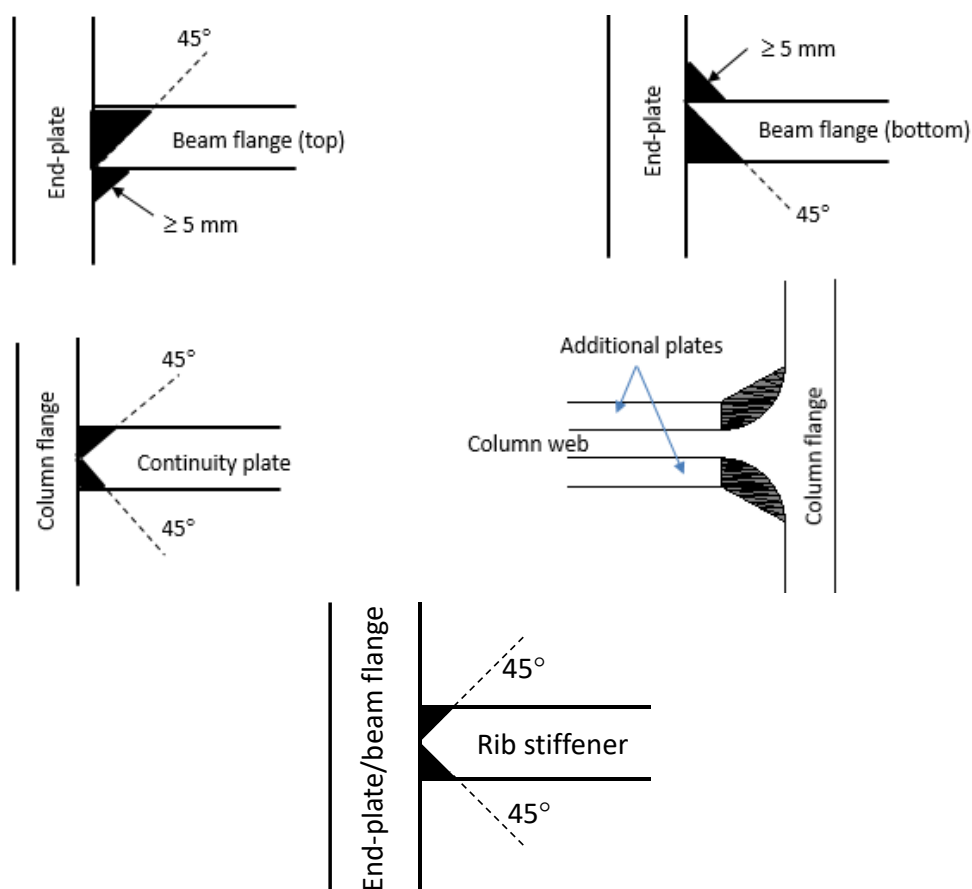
Detalhes das juntas com soldaduras em bordos arredondados com penetração total
